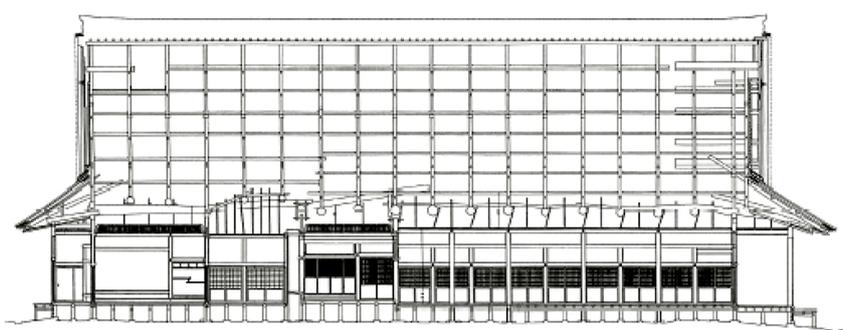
西本愿寺木结构体系示意图与正立面图。来源：Traditional Japanese wood construction [6]
